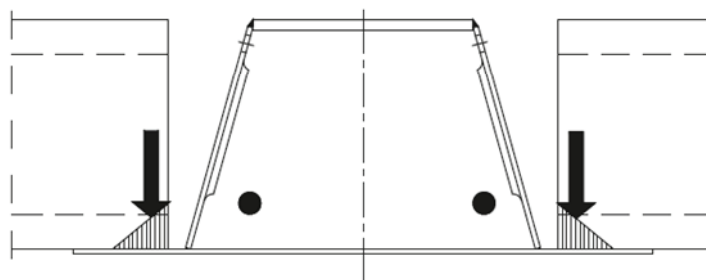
Схема передачи нагрузки на балку в период монтажа
